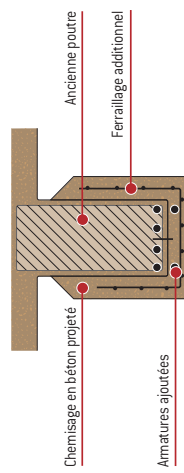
Exemple de renforcement d'une poutre par béton projeté (coupe transversale)
